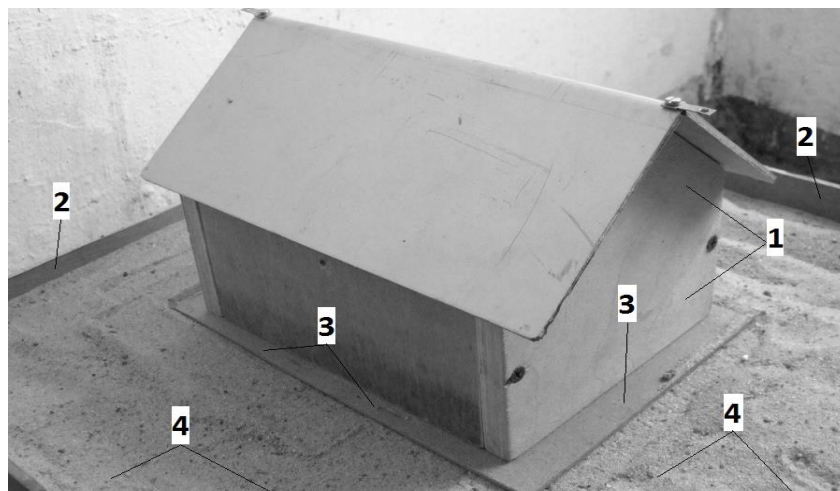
Схема испытаний. 1 – модель здания; 2 – грунтовый лоток; 3 – плитный фундамент; 4 – грунтовое основание
